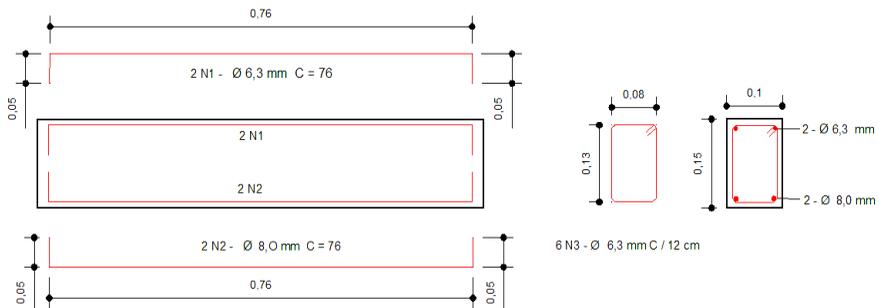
Detalhamento das armaduras das vigas (CARNEIRO, 2013).
